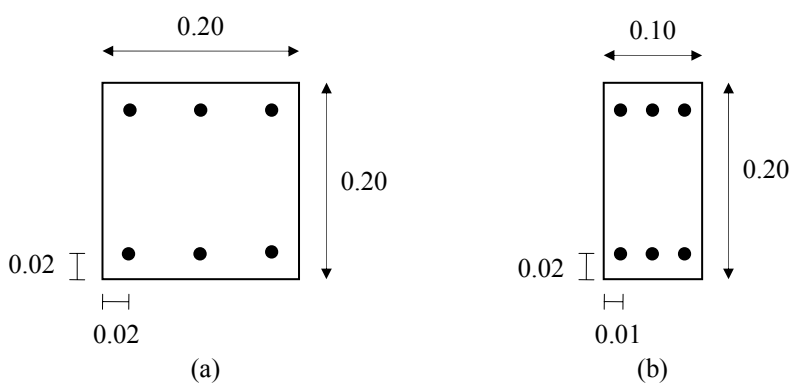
Sección transversal tipo. Distribución de armadura simétrica en caras opuestas.
